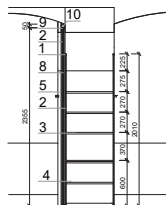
DETAIL A - POSUVNÝCH DVEŘÍ 1:5
